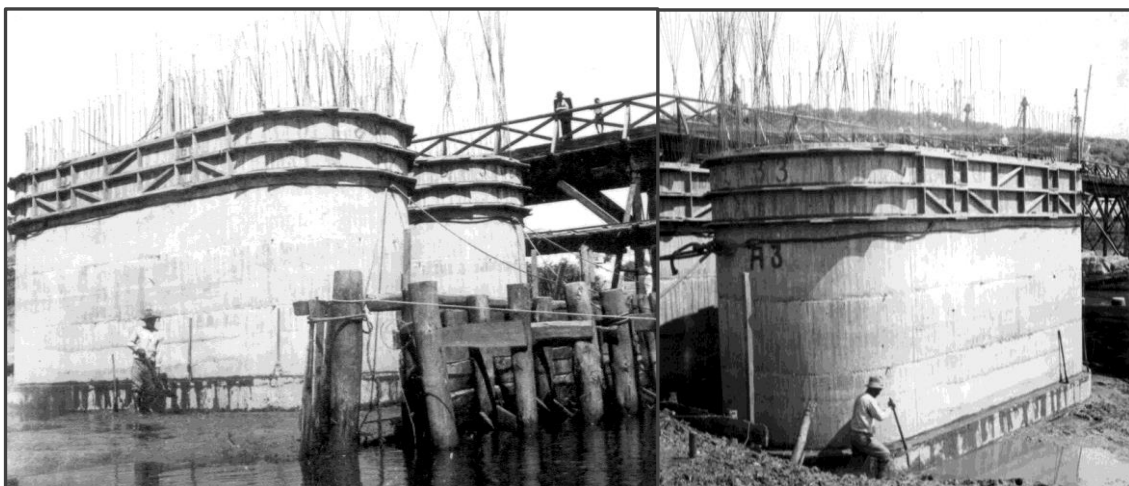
Conclusão da betonagem de pré-fabricação e início da escavação da península de aterro
